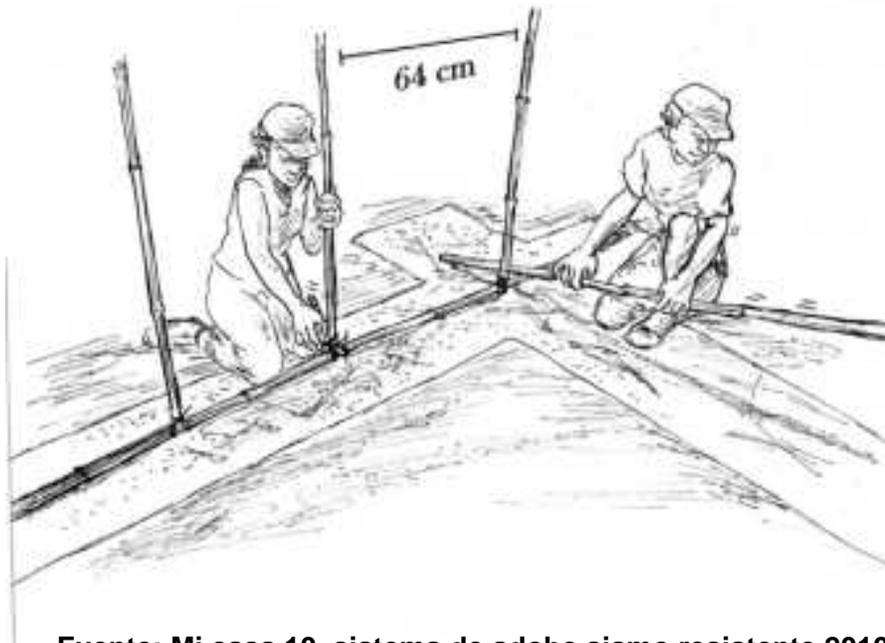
Segunda hilada de paredes con adobe rectangular
